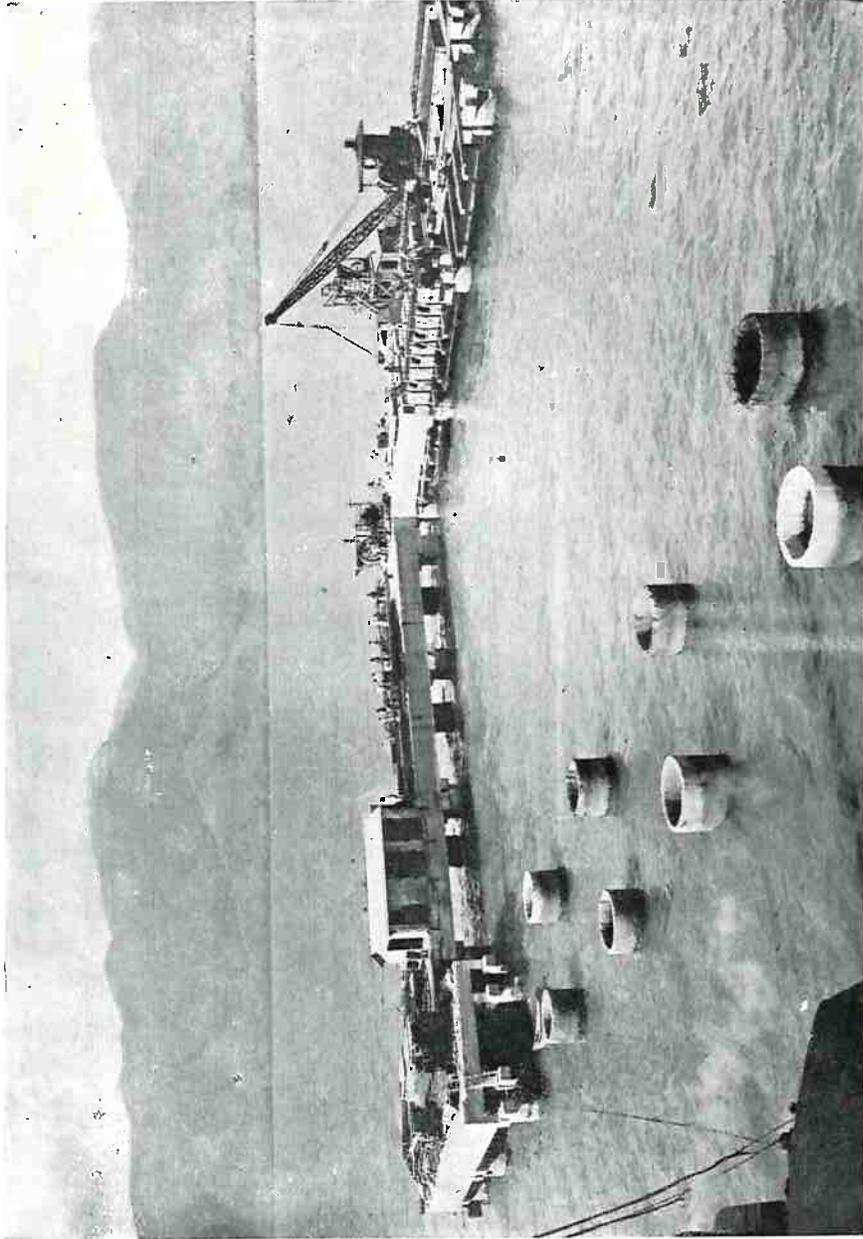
Vista da construção do porto de S. Sebastião, mostrando os tubulões cravados e um trecho de estrado construído.
